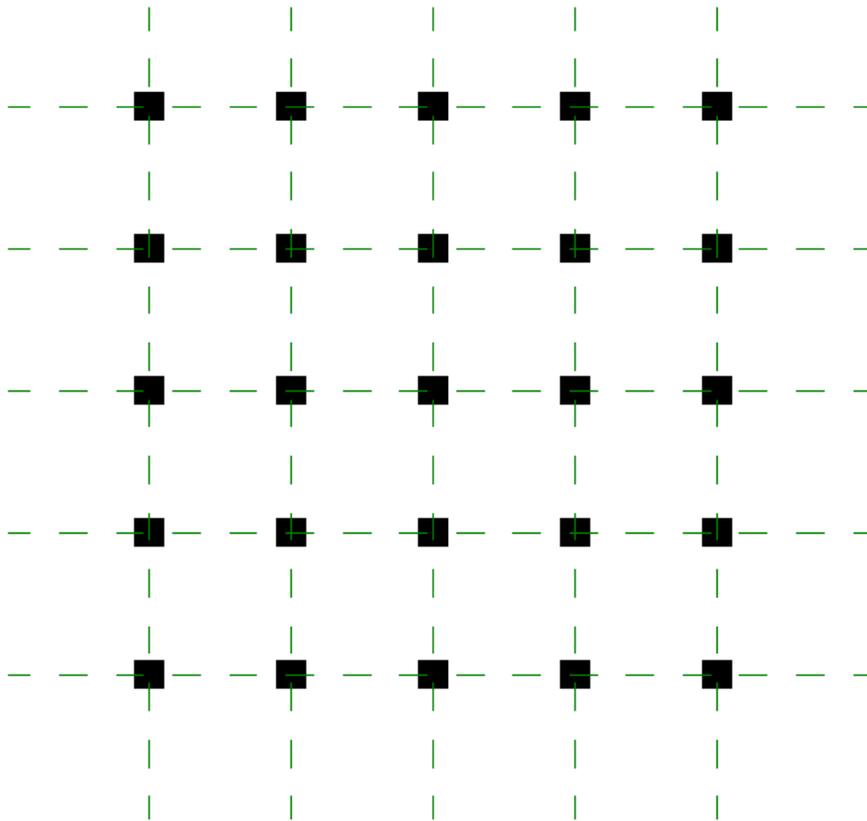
Gría Modulación de Columnas a cada 8.00 metros
